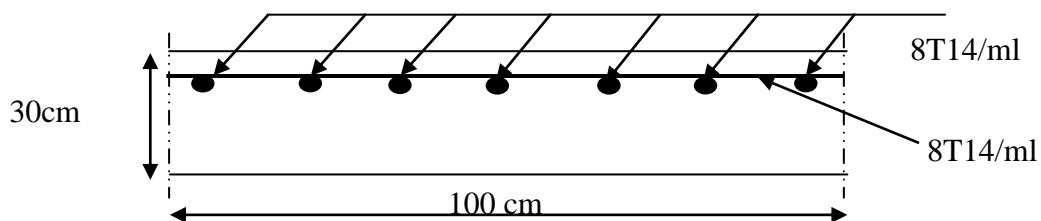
Coupe A-A ferrailage du panneau du radier sens x-x et y-y
